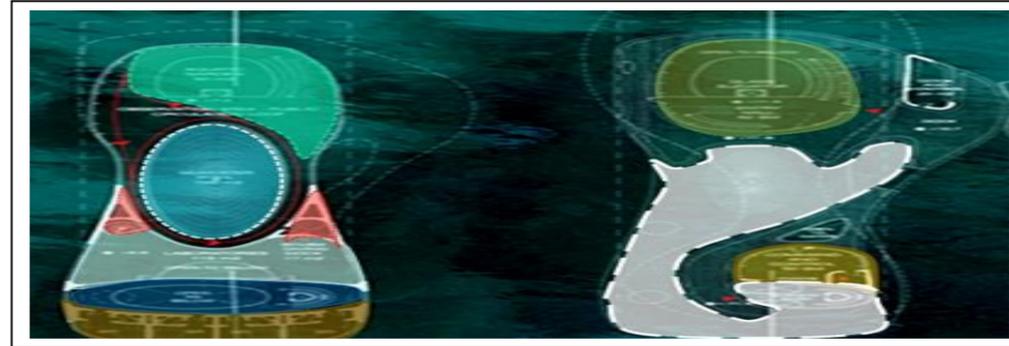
Plan du 1^{er} niveau sous la mer, plan du 1^{er} niveau sur la mer ; Source : planet techno traitée par auteurs.
